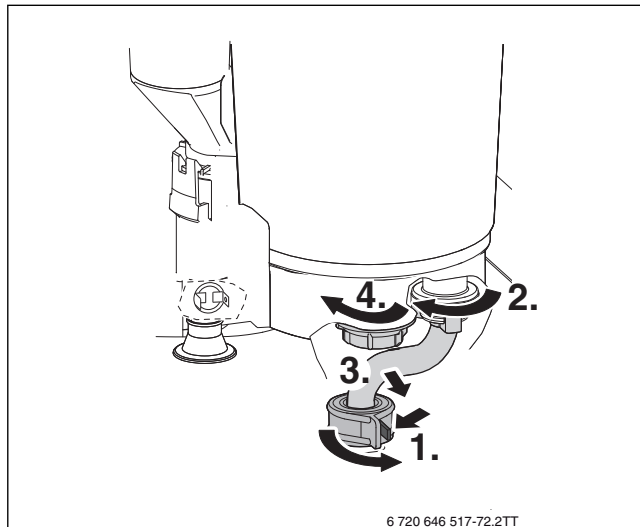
Mutter entfernen und Rücklaufrohr lösen
